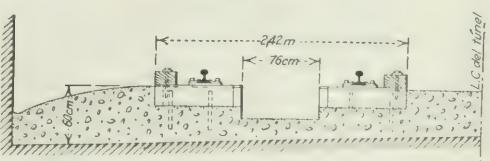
VÍA RÍGIDA DE HORMIGÓN PARA TÚNELES
